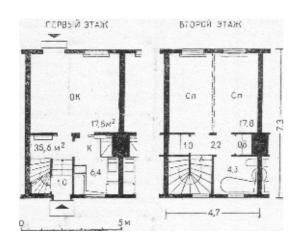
Трехкомнатная квартира блокированного дома (Швеция)
